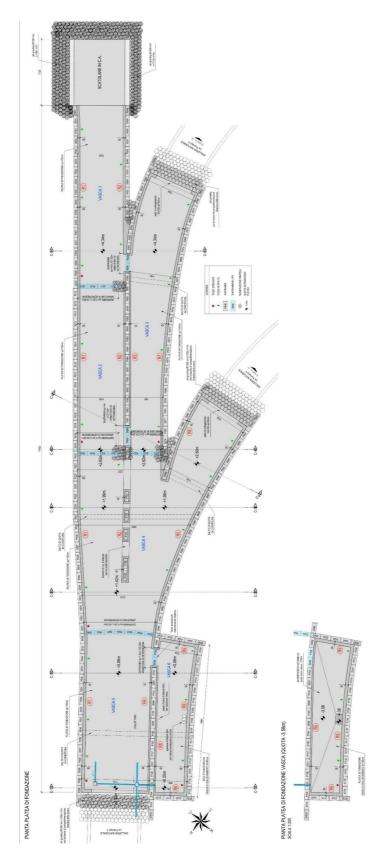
Galleria artificiale Fornaci II – Planimetria di progetto
